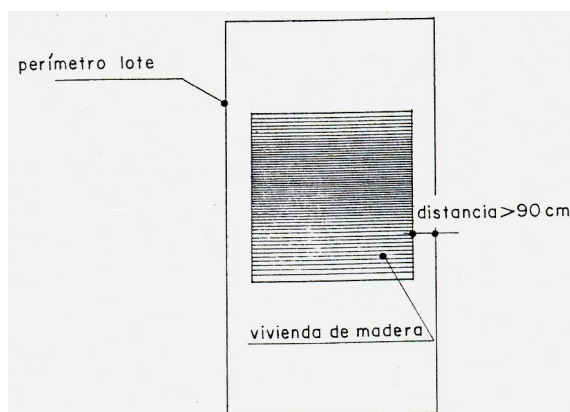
Detalle de separación y protección de viviendas de madera.
